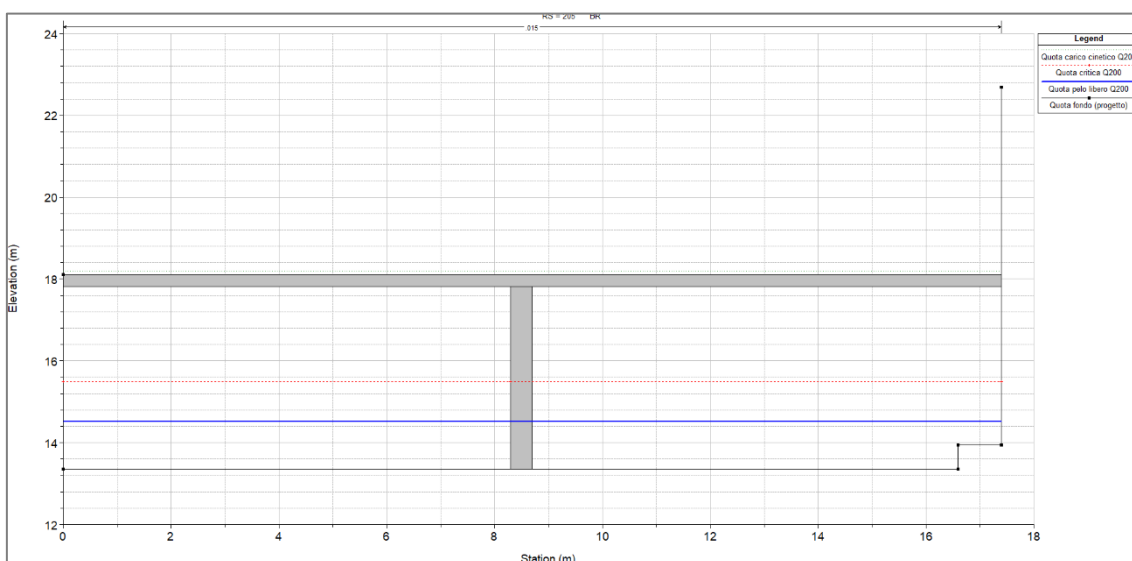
Sezione della passerella privata nello stato di progetto (con nuova pila)
